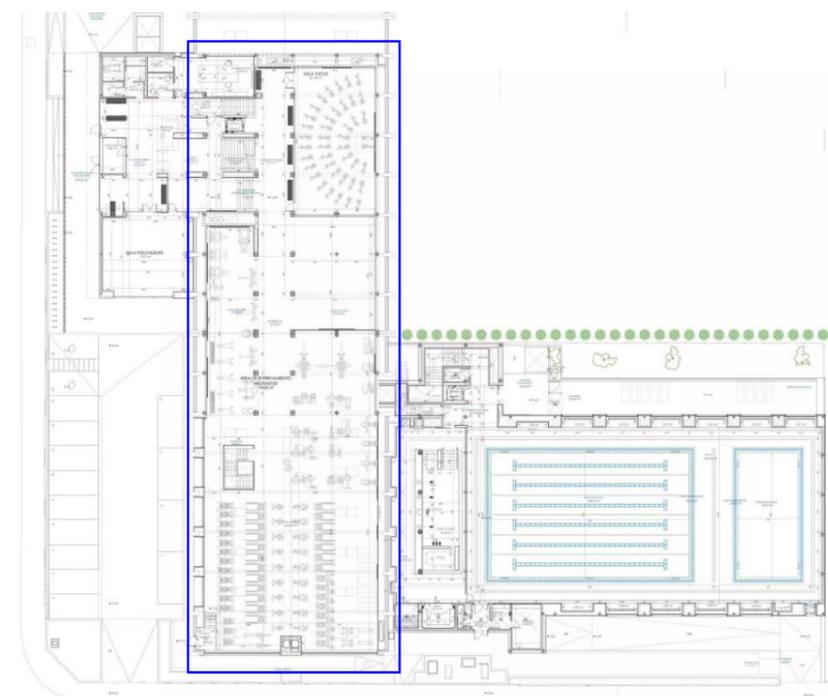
Planta baja del nuevo proyecto de instalaciones deportivas. En azul, el trazado de la nave de Forjas
